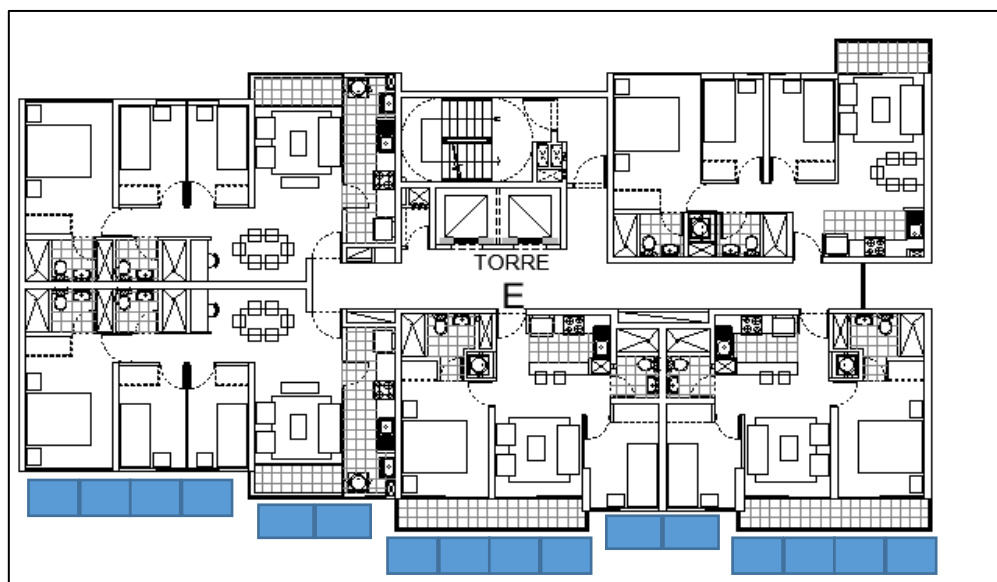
Esquema posición andamios fachada Av. Santa Callao
